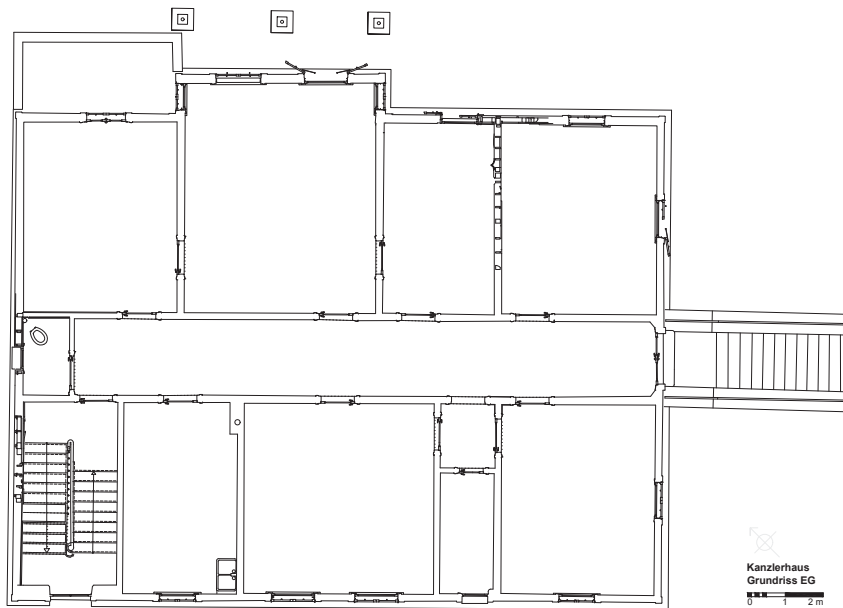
Grundriss des Erdgeschosses, M. 1:200
